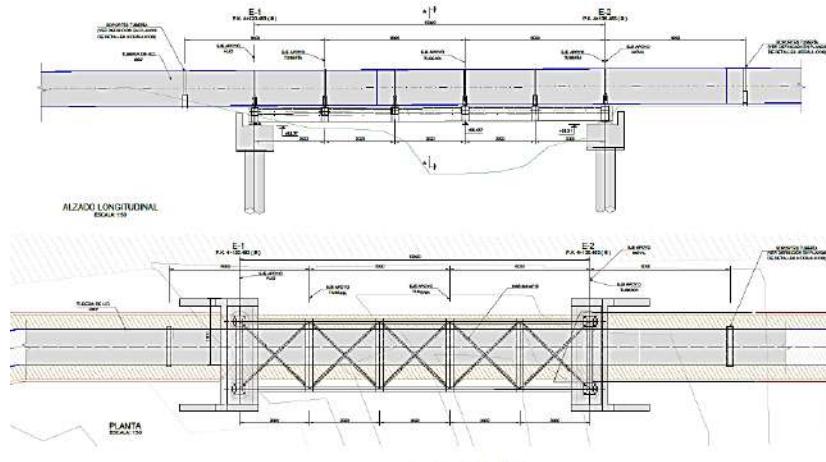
Estructura tipo puente elevado para soporte de tubería de aducción sobre río Camacho (intersección C)
